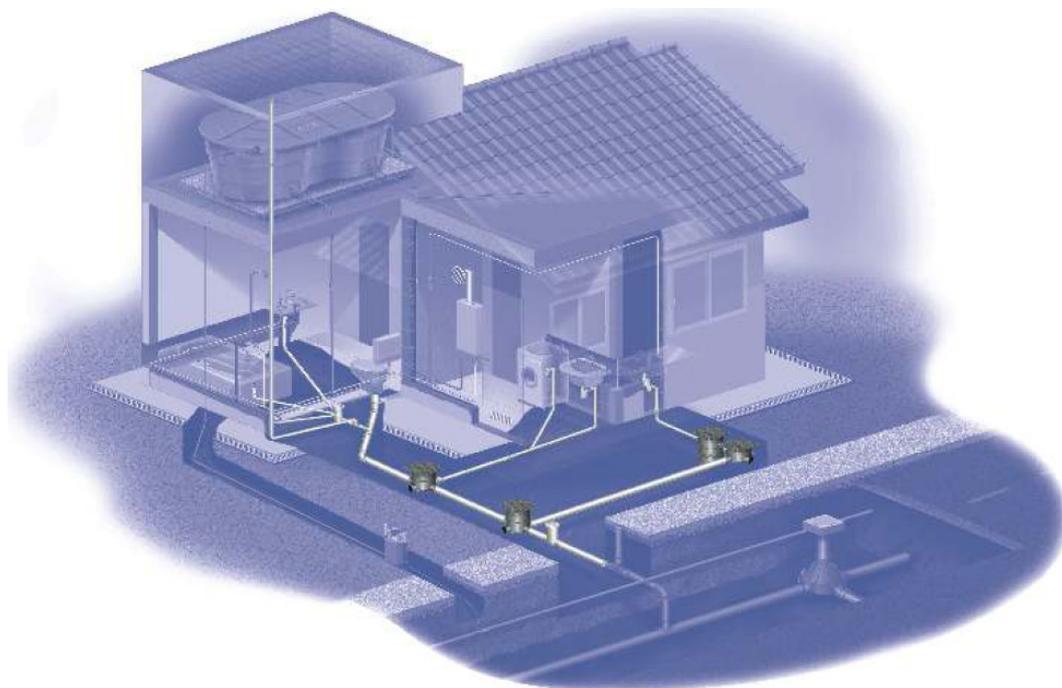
Vista geral da distribuição de um sistema esgoto sanitário
